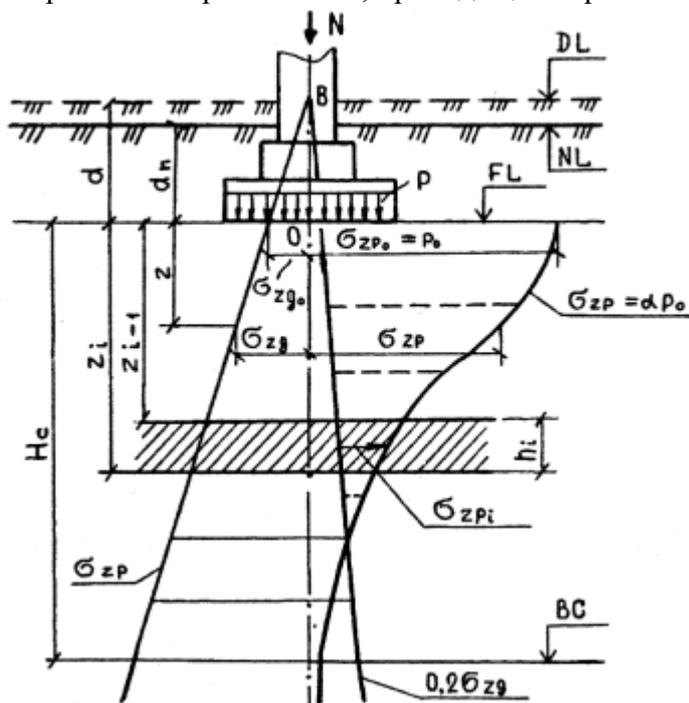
Расчетная схема для определения осадки методом послойного суммирования: DL — отметка планировки; NL — отметка поверхности природного рельефа; FL — отметка подошвы фундамента; BC — нижняя граница сжимаемой толщи;  $H_c$  — сжимаемая толщина
